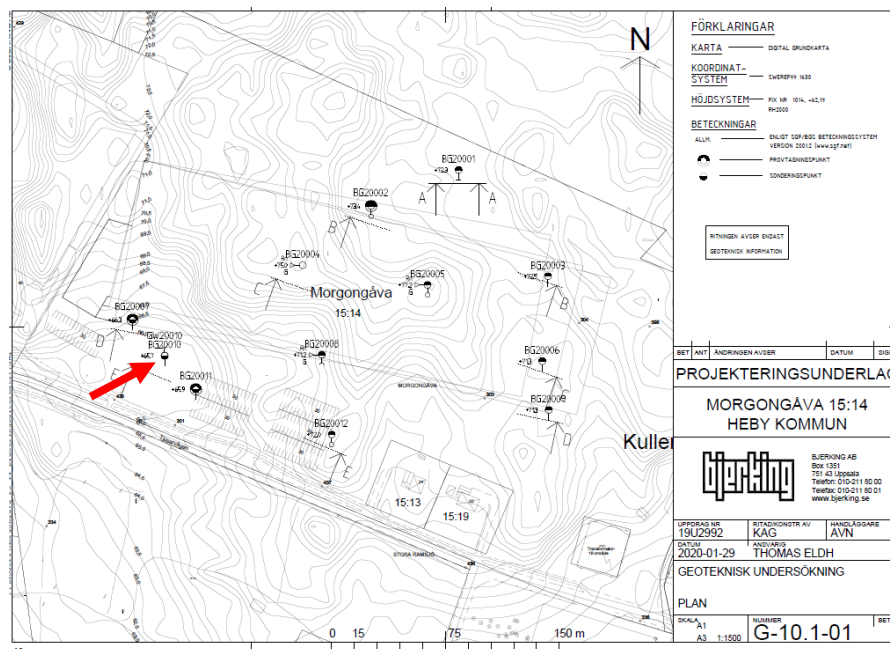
Grundvattenrörets placering visas med röd pil. (Geoteknisk utredning, Bjerking)
